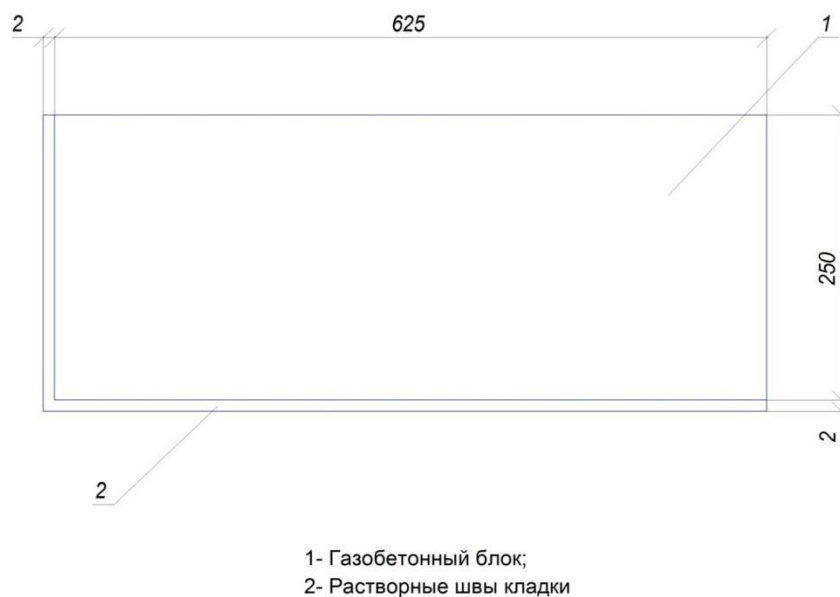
Схема регулярно повторяющегося элемента стены из газобетонных блоков со швами на клею
